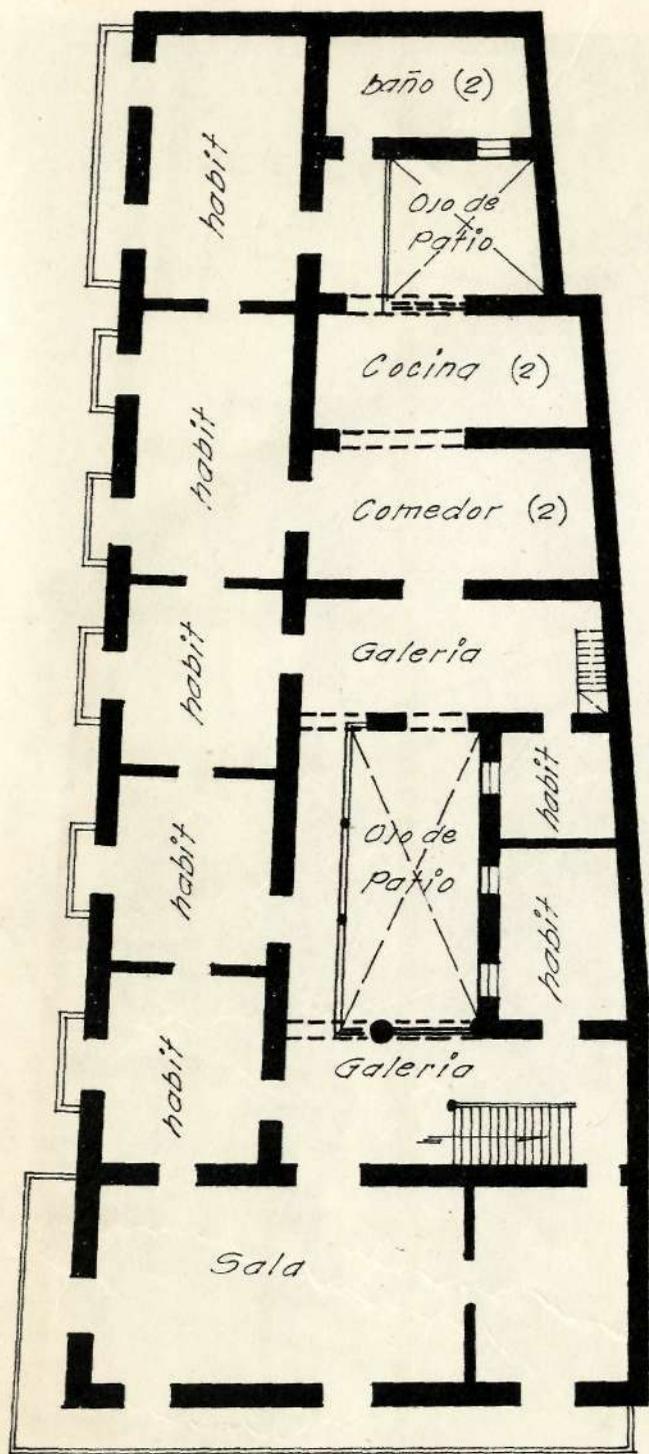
Casa en Cuba esq. a Cuarteles: planta baja.
